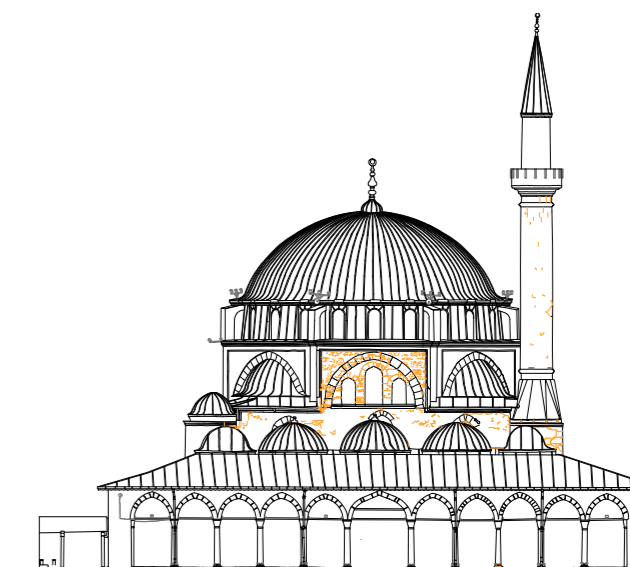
uadro fessurativo prospetto Nord-Ovest.pdf
